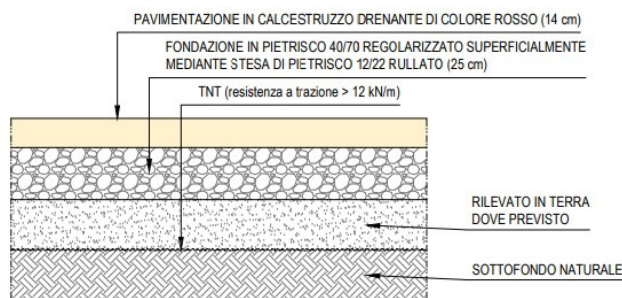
Dettaglio pavimentazione ciclabile in calcestruzzo drenante
